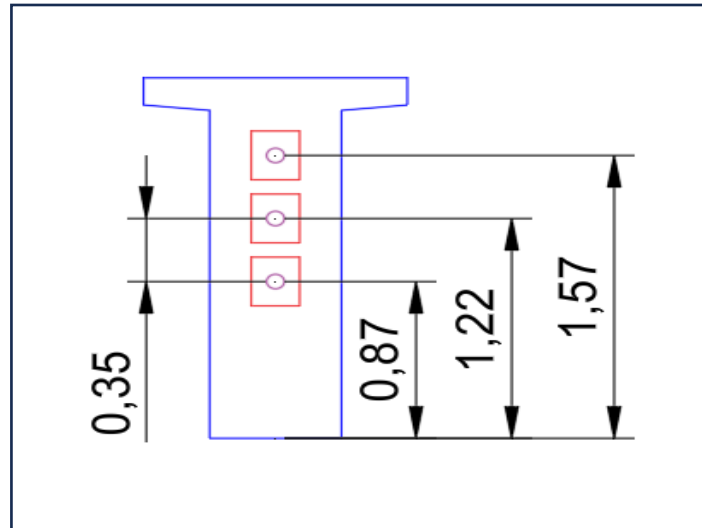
Disposition des câbles de précontraintes dans la section d'about
